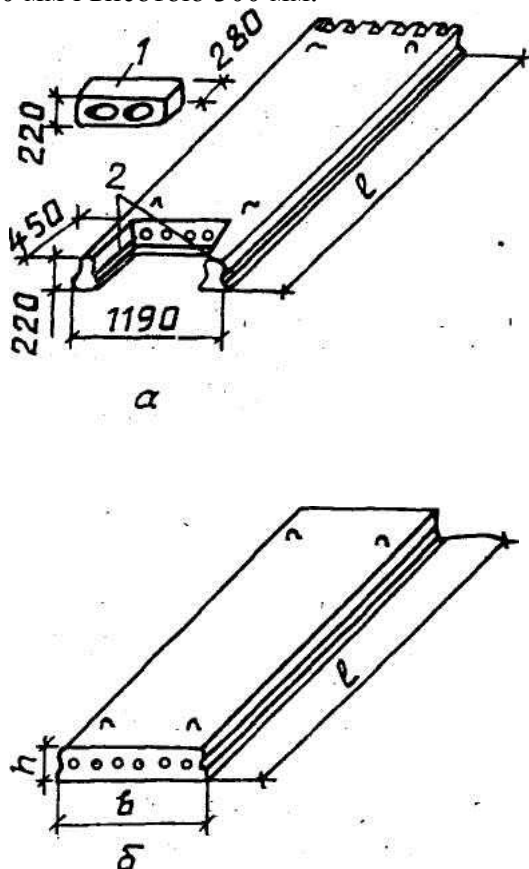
Великорозмірні збірні залізобетонні конструкції перекриттів:
